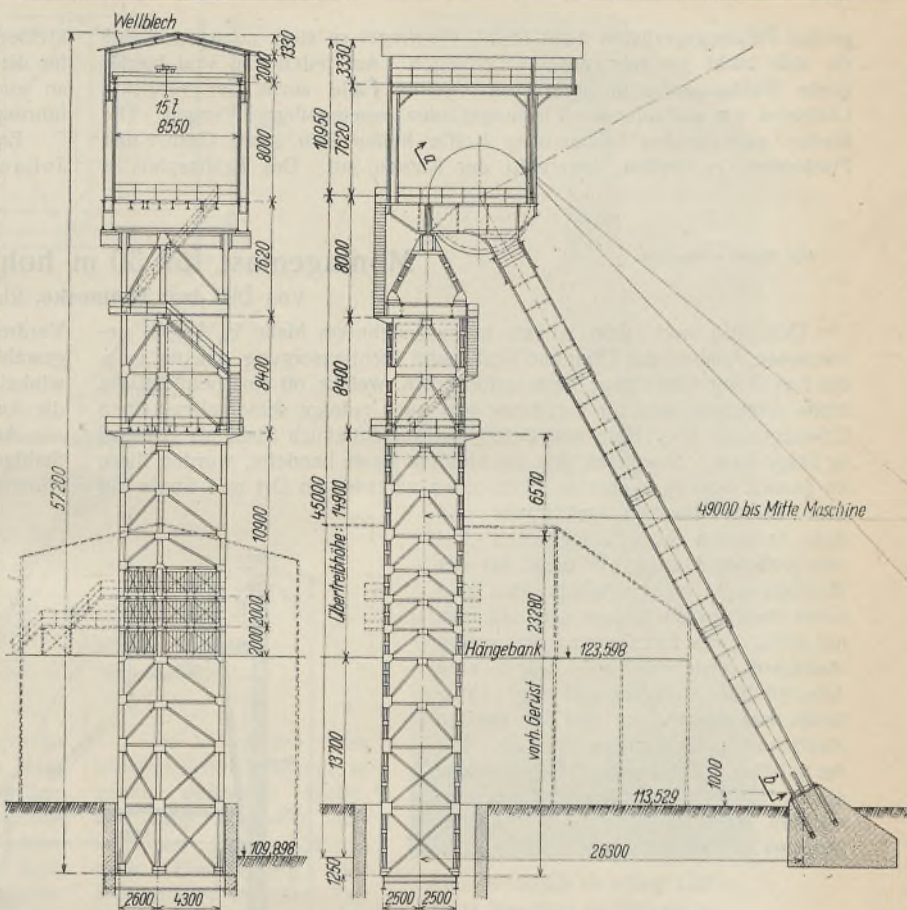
Fördergerüst Schacht Arnold der Großschachanlage „Robert Muser“. Querschnitt und Ansicht.
